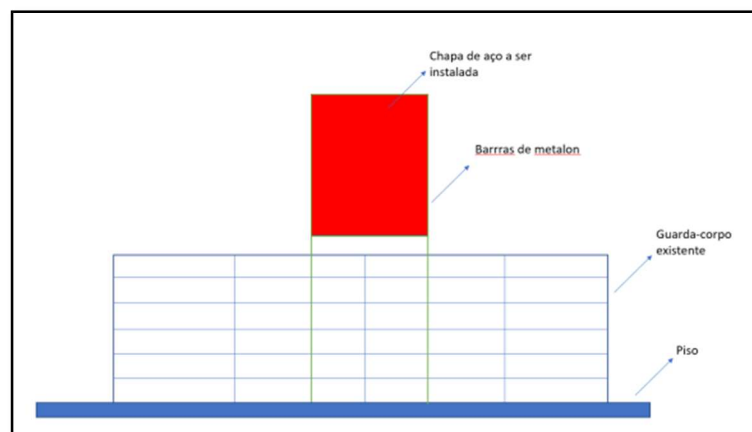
Foto ilustrativa de chapa de aço a ser instalada
